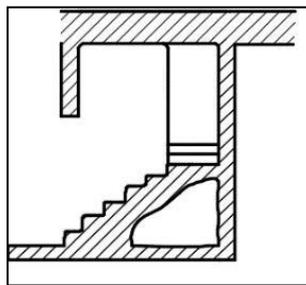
coupe de l'escalier. Source: fait par l'auteur
